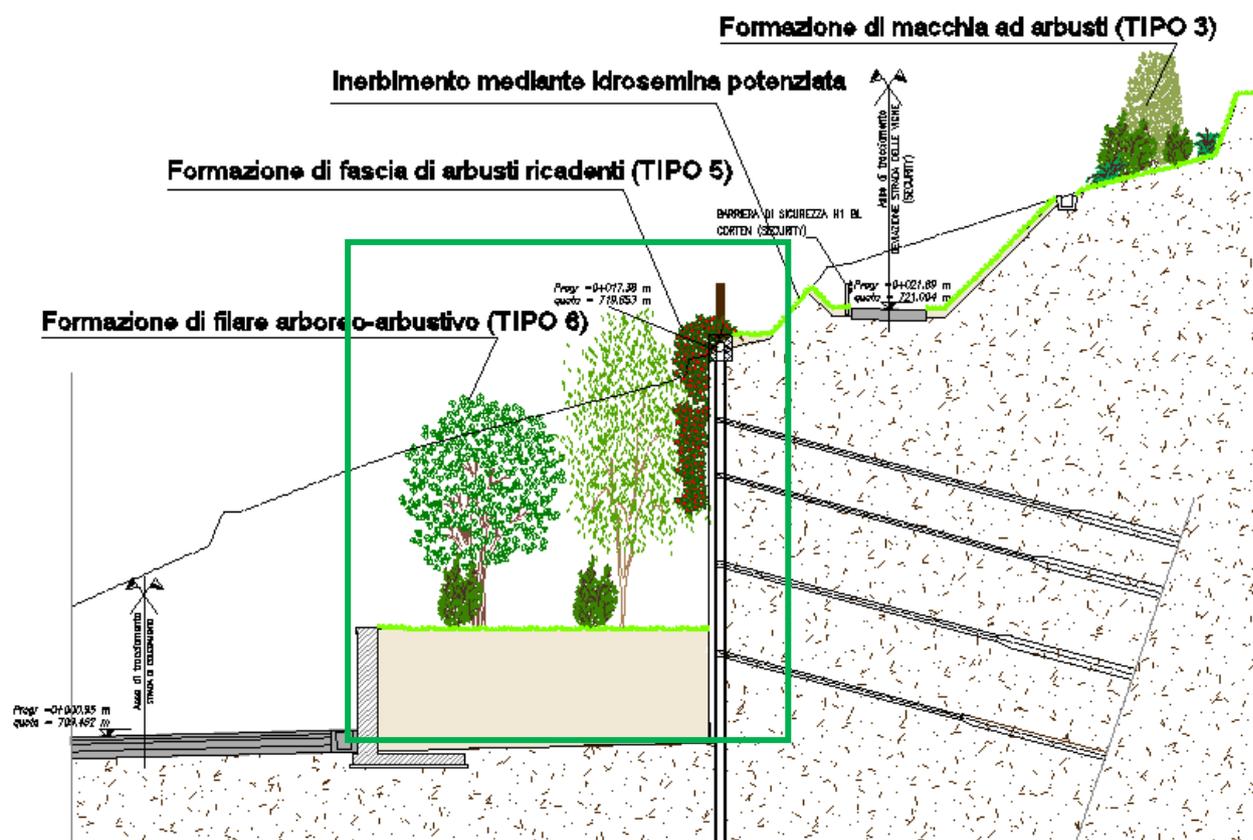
Mascheramento muri con piantumazione di specie ricadenti
